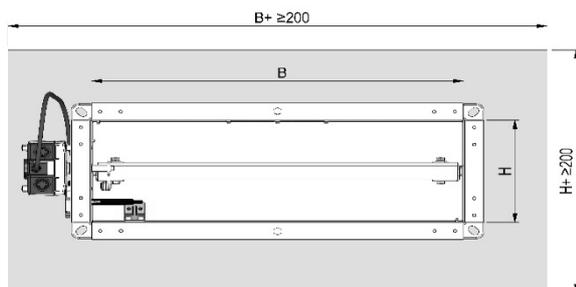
Einbau in massive Decken mit Betonsockel, Draufsicht
